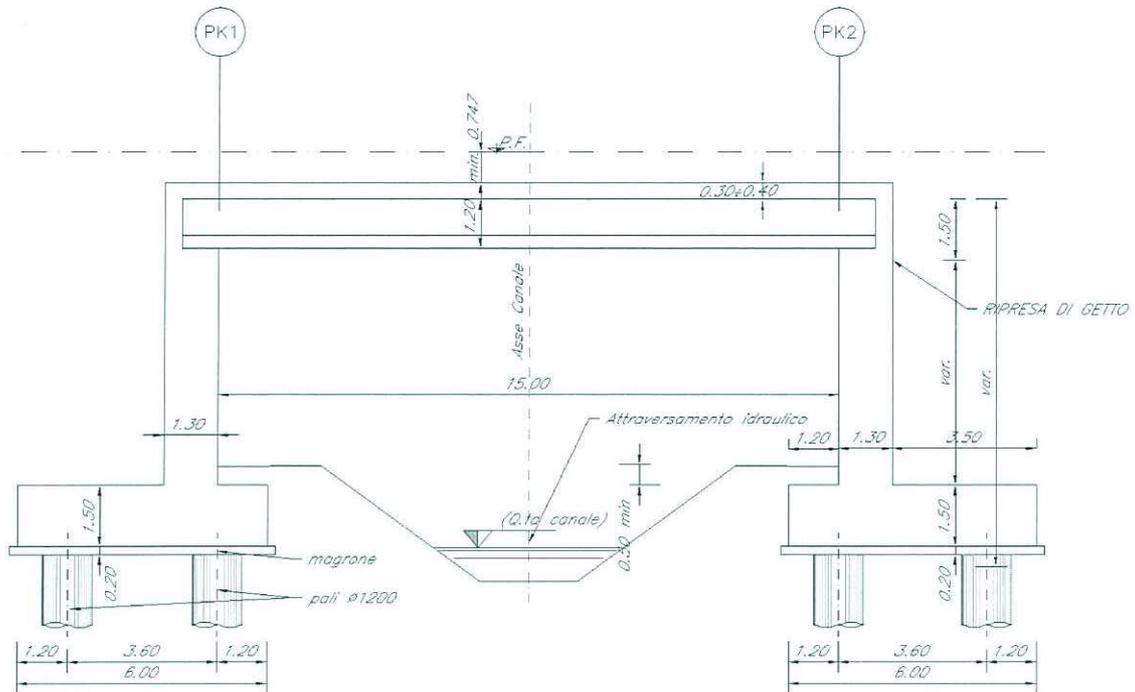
Prospetto in corrispondenza di attraversamento idraulico.
